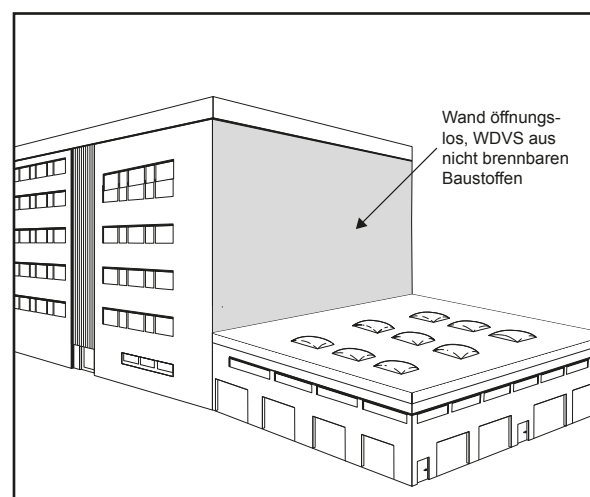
Ausführung der Außenwand mit WDVS beim Anschluss an ein Dach mit brennbaren Baustoffen
